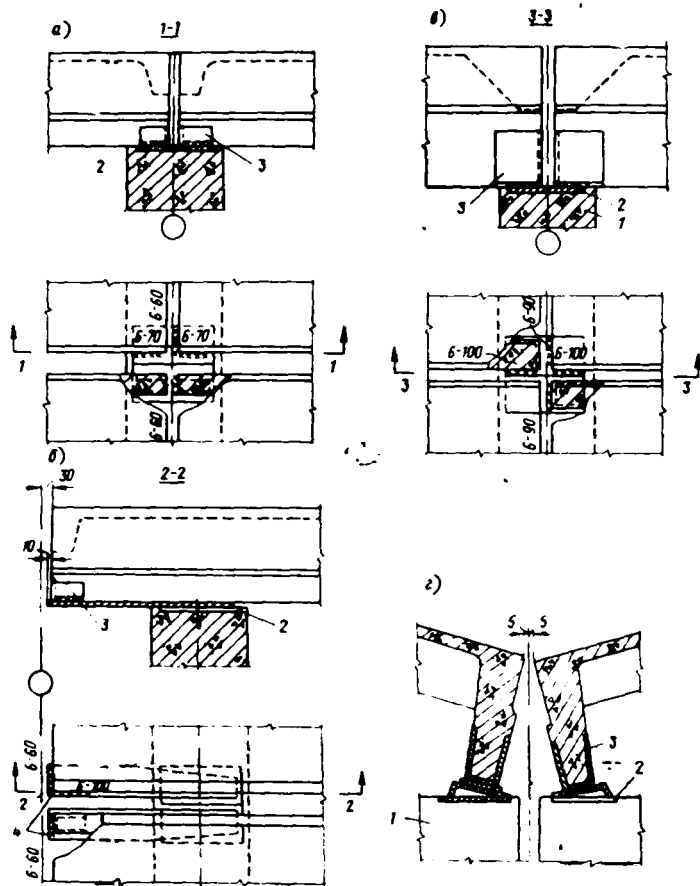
Детали крепления плит покрытий к фермам зданий со скатной кровлей
